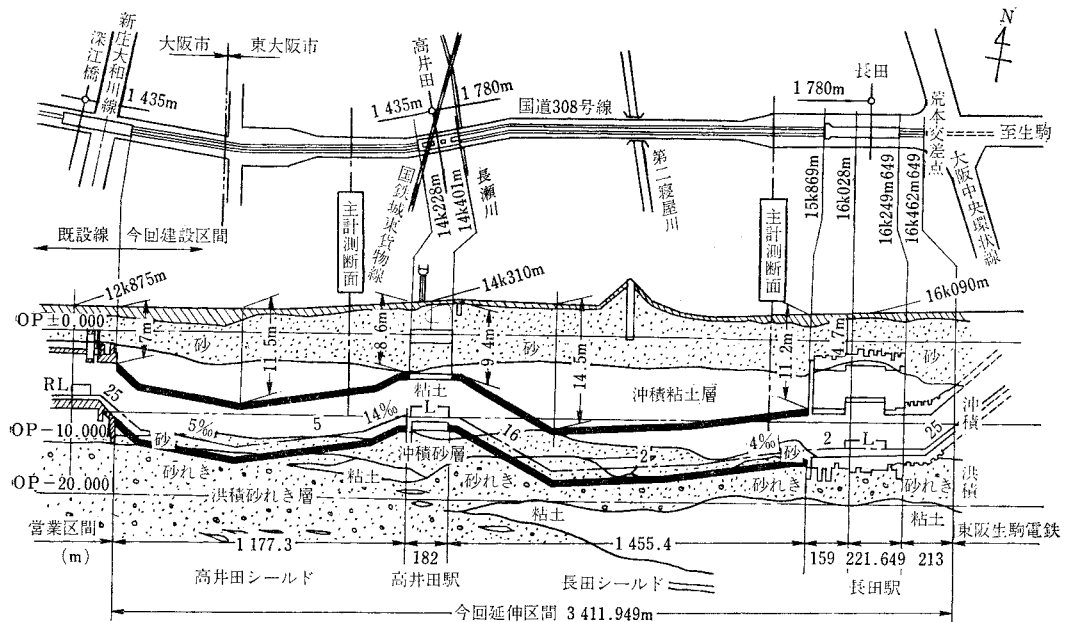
地下鉄4号線深江崎~長田間線路平面縦断面
